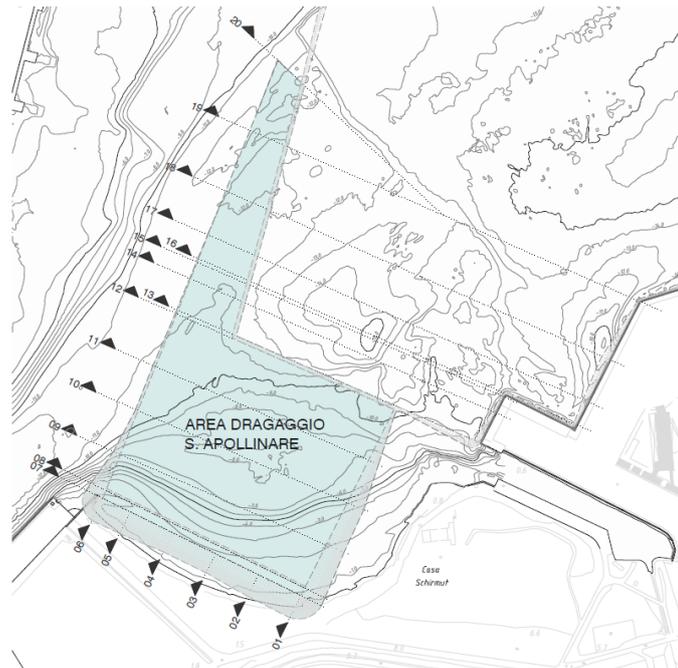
Stralcio della planimetria generale di dragaggio (Cfr. 09-017-DT-202-0-PLA)
